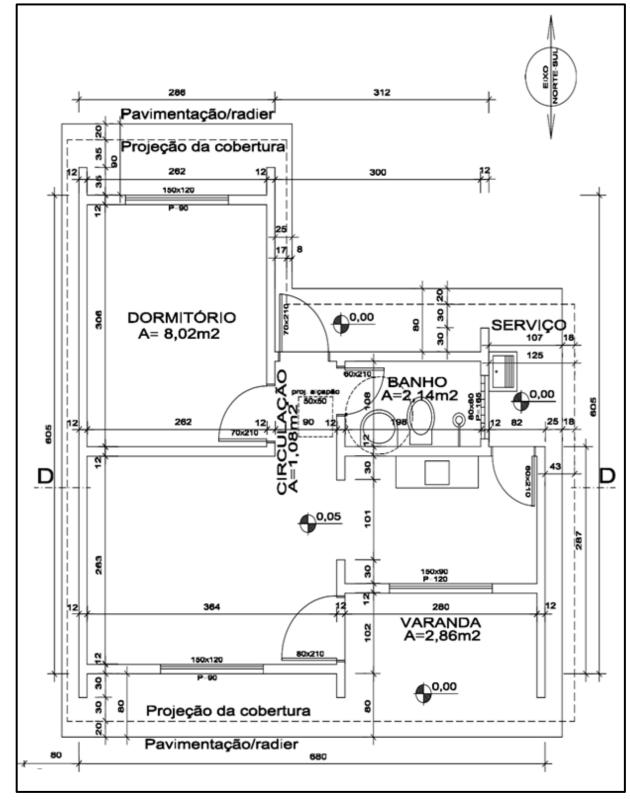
Planta baixa da construção de uma casa com área de 32,35m²
